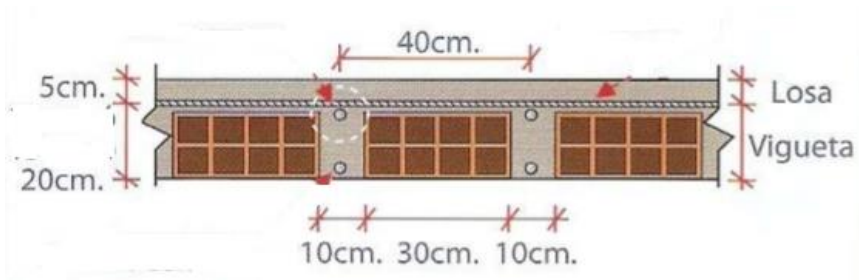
Detalle de la losa aligerada de 25 cm. de la estructura 1.
